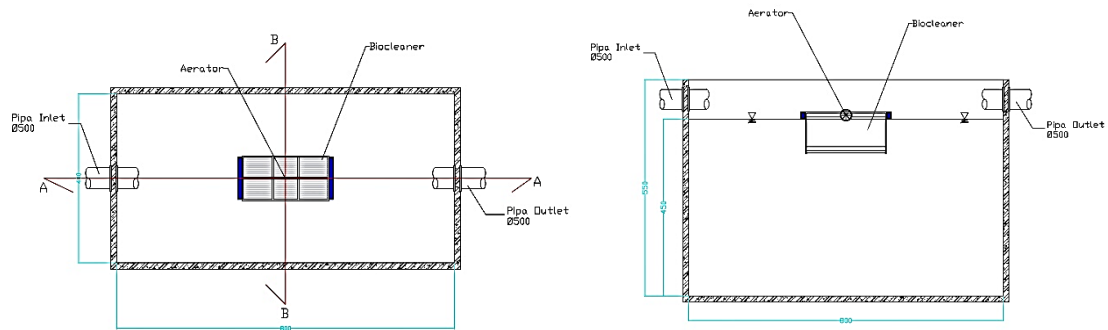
Denah RBC (kiri) dan Potongan A-A (kanan)
